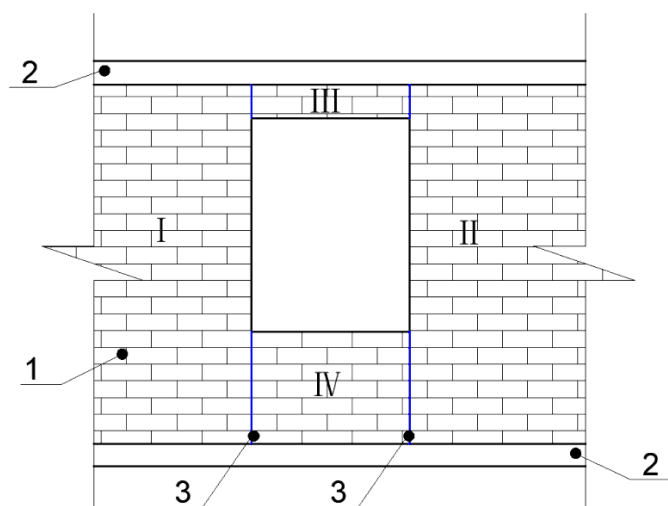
Схема расположения вертикальных деформационных швов в облицовочной кирпичной кладке: I, II, III, IV – фрагменты облицовочной кирпичной кладки; 1 – облицовочная кирпичная кладка; 2 – монолитное железобетонное перекрытие; 3 – вертикальные деформационные швы
